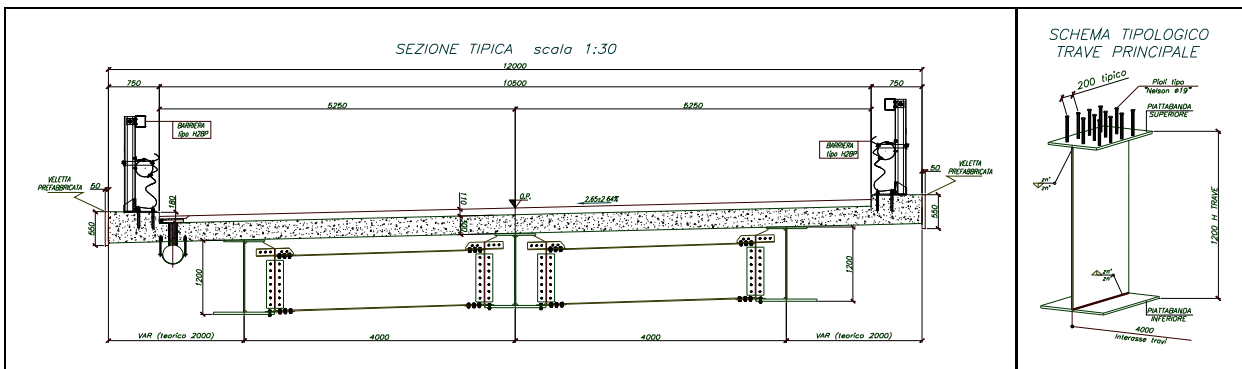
Sezione tipo dell'impalcato e schema tipologico trave principale stralcio assonometrico
